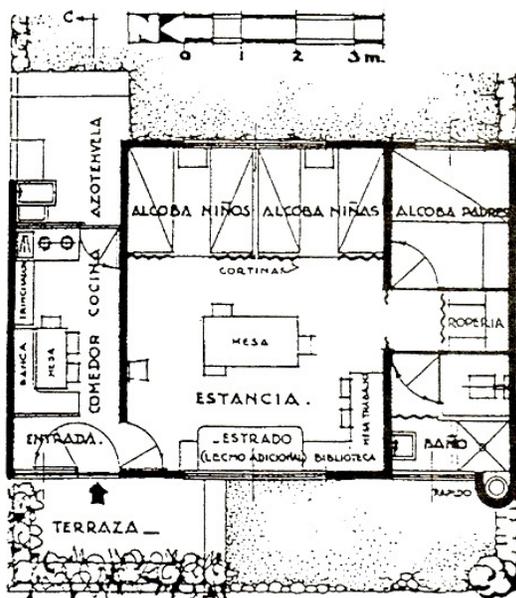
Planta arquitectónica del proyecto de Juan Legarreta, 1932. Fuente: Boils, 1995:19.
